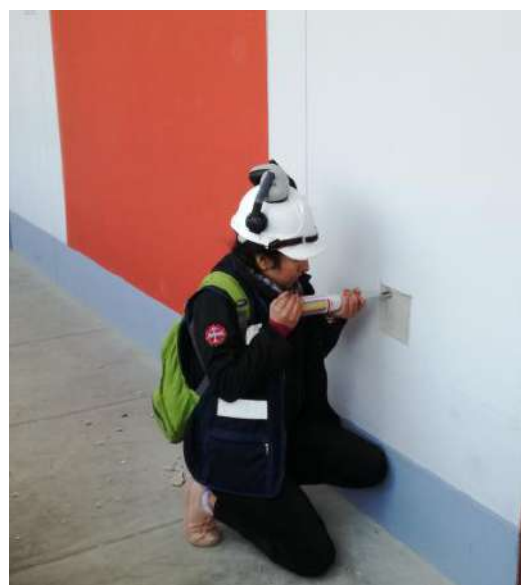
y 18: Ensayo de esclerometría en columnas y vigas el módulo 02, segundo nivel
